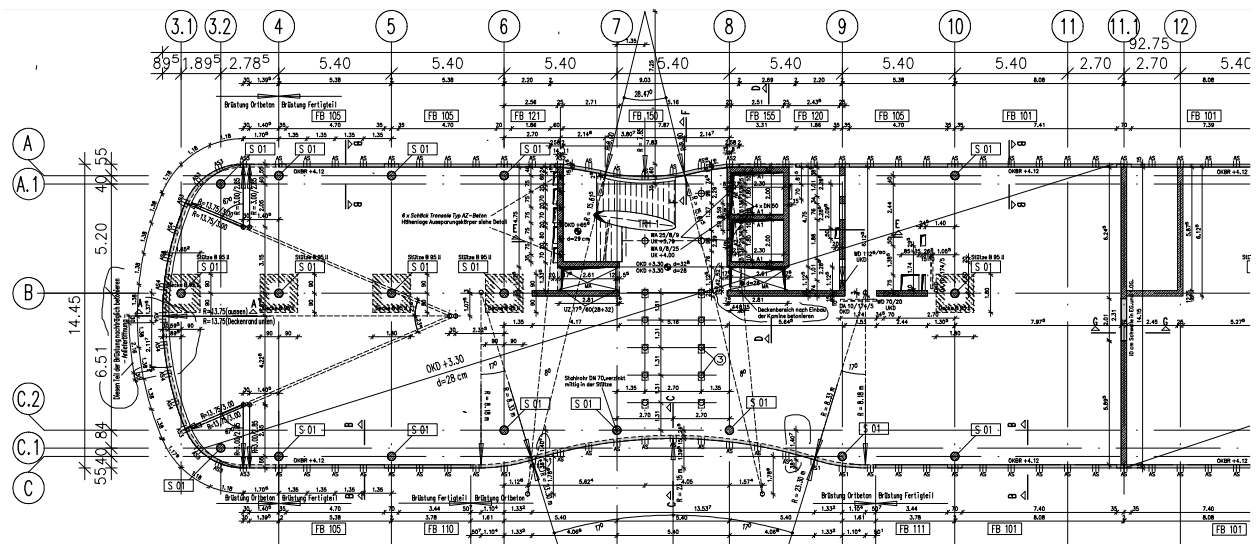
Ausschnitt Schalplan OG
